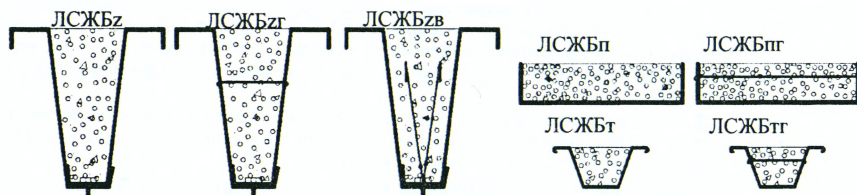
Типы лёгких сталежелезобетонных балок
